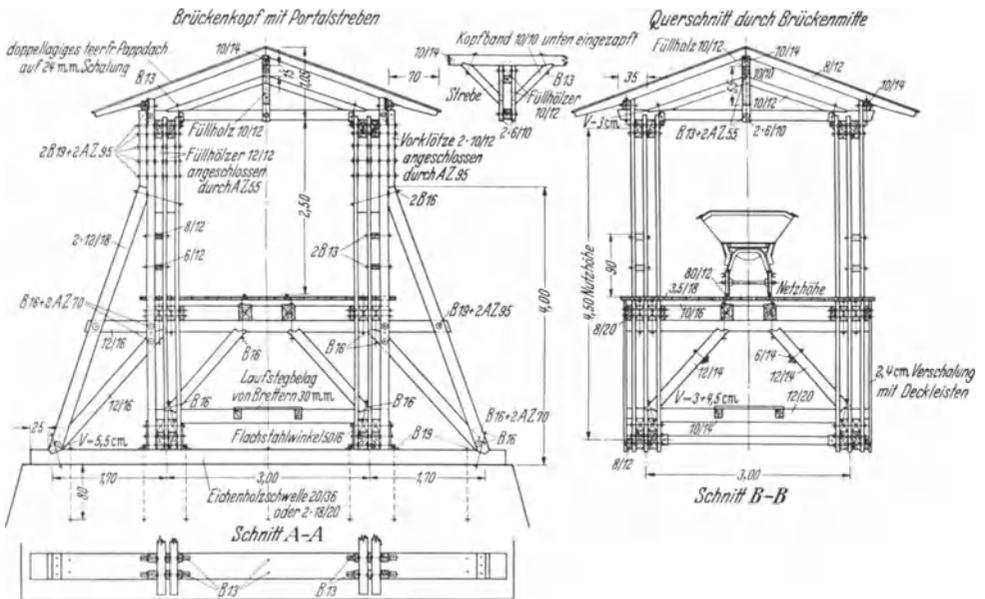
Brückenkopf mit Portalstreben und Querschnitt durch Brückenmitte (zu Abb. 123).
